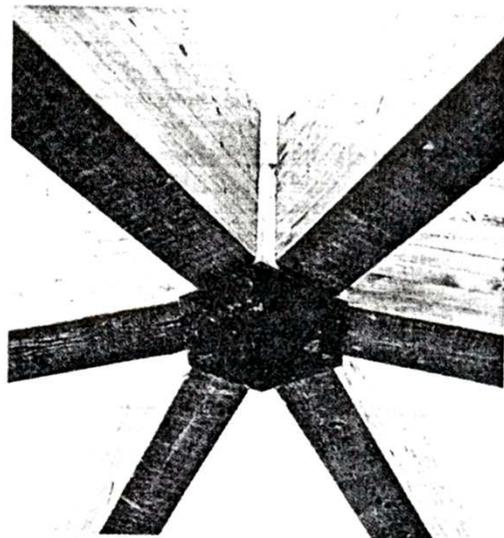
Coperture con struttura portante in travi lamellari (FOTO GEBA, DERKS)
